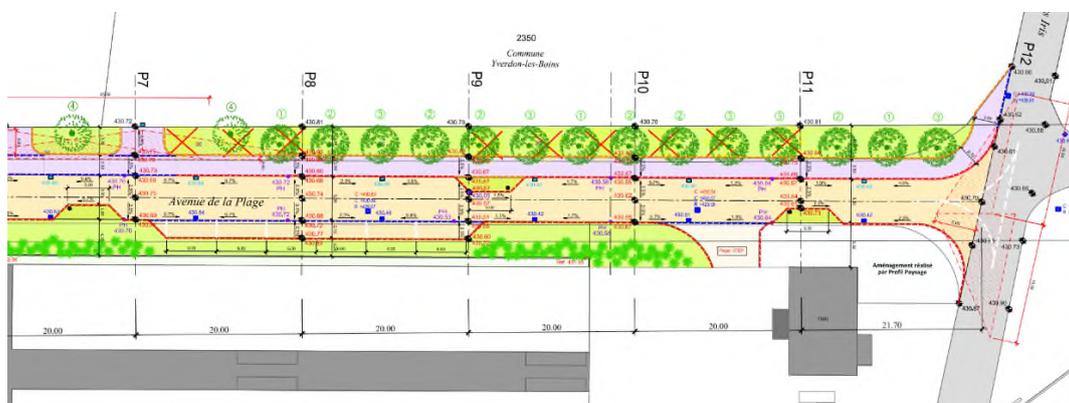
plan de situation (1/2 tronçon Nord)
